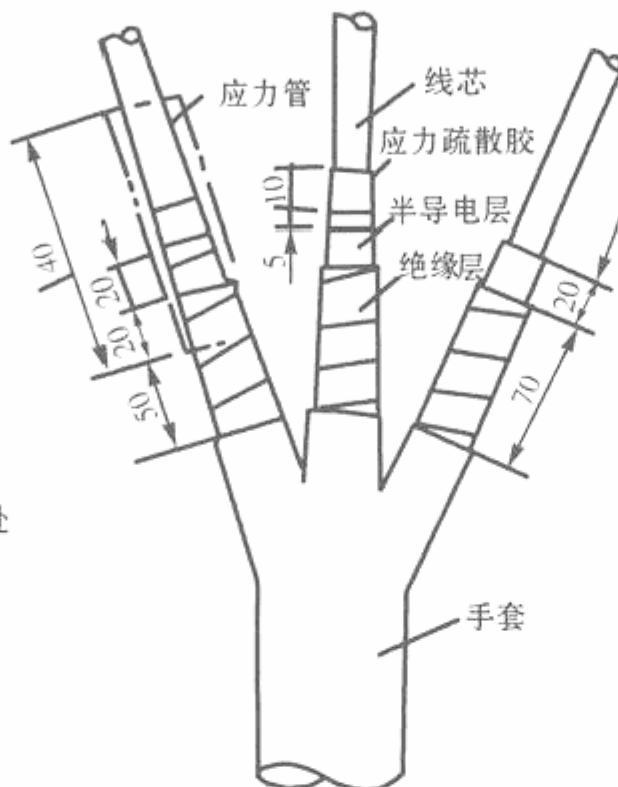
铜屏蔽层、半导电层剖削尺寸 (mm)
